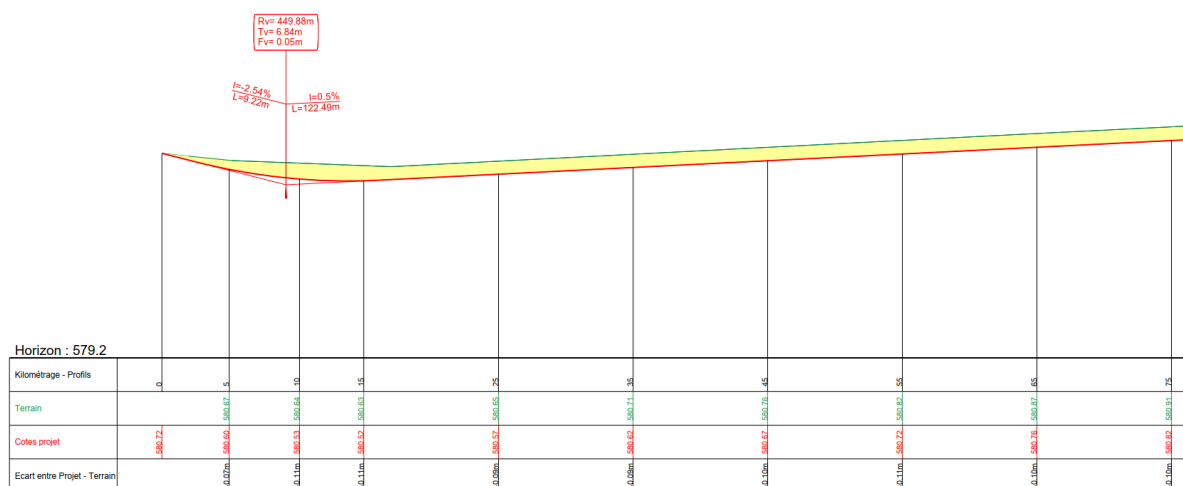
Profil en long de l'axe de chaussée du pont de Zaehringen
